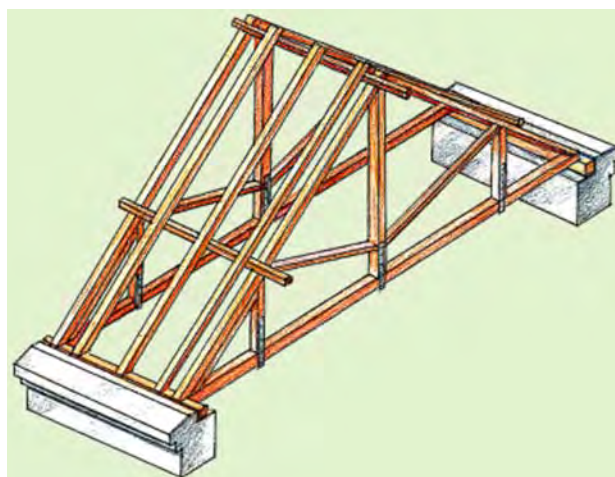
Висячие стропила опираются только на две крайние опоры (например, только на стены здания без промежуточных опор). Стропильные ноги соединяются затяжкой, препятствующей их разъезжанию
